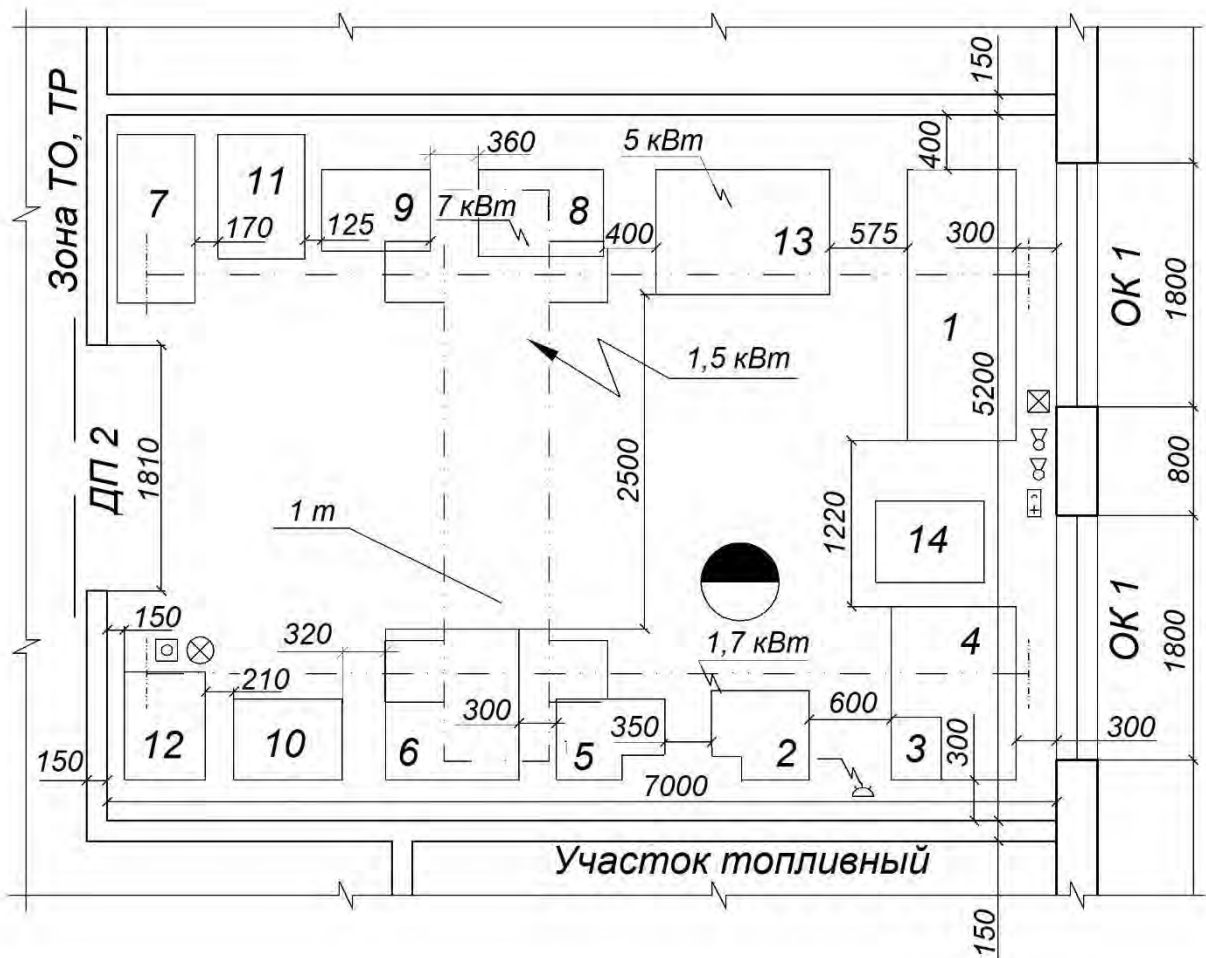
Планировочное решение агрегатного участка: 1 – стенд для ремонта КП; 2 – станок вертикально-сверлильный; 3 – пресс верстачный, реечный, ручной; 4 – верстак; 5 – стенд для разборки передних мостов с рессорами; 6 – стенд для сборки и разборки двигателя; 7 – стеллаж секционный; 8 – станок фрезерный; 9 – стенд для ремонта редукторов задних мостов; 10 – стенд для разборки и сборки рулевых механизмов; 11 – станок обдирочно-шлифовальный, передвижной; 12 – ванна моечная; 13 – станок токарный; 14 – тележка
